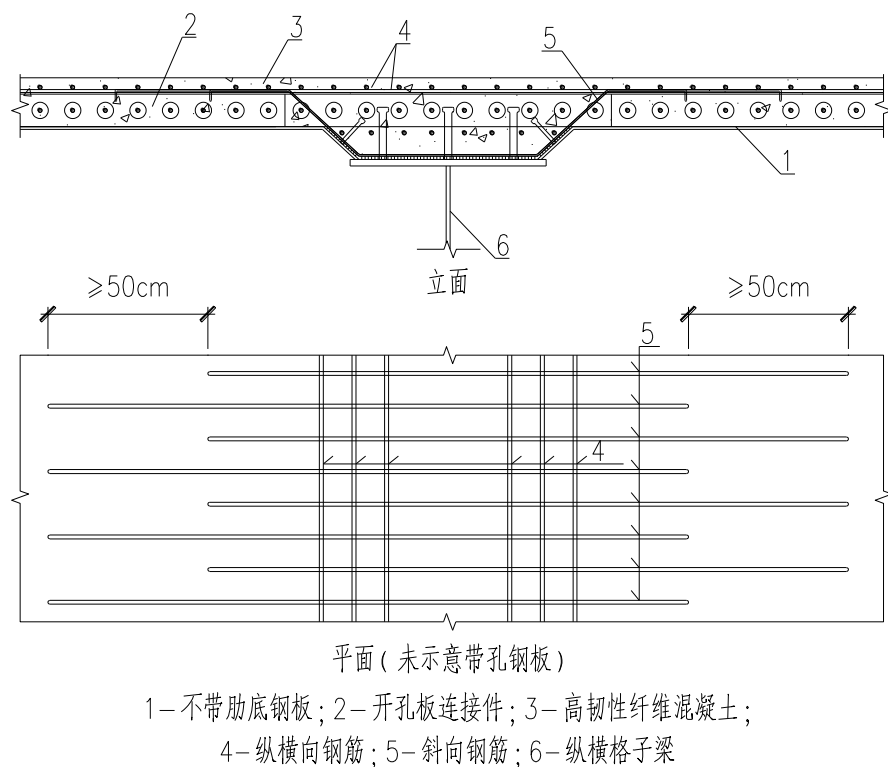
负矩区段加腋处斜向钢筋的构造
